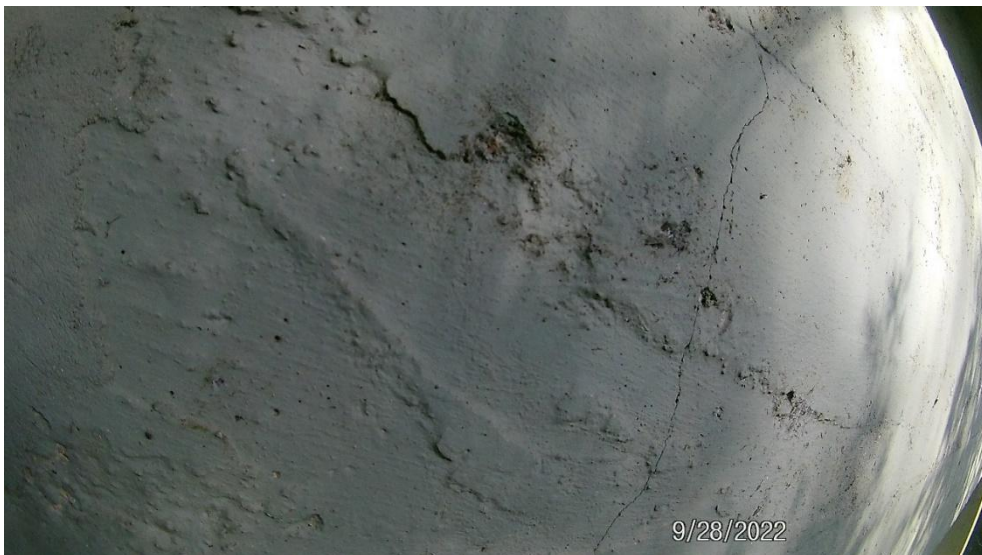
VL2 - Fissura vertical entre os apoios P1/P2
